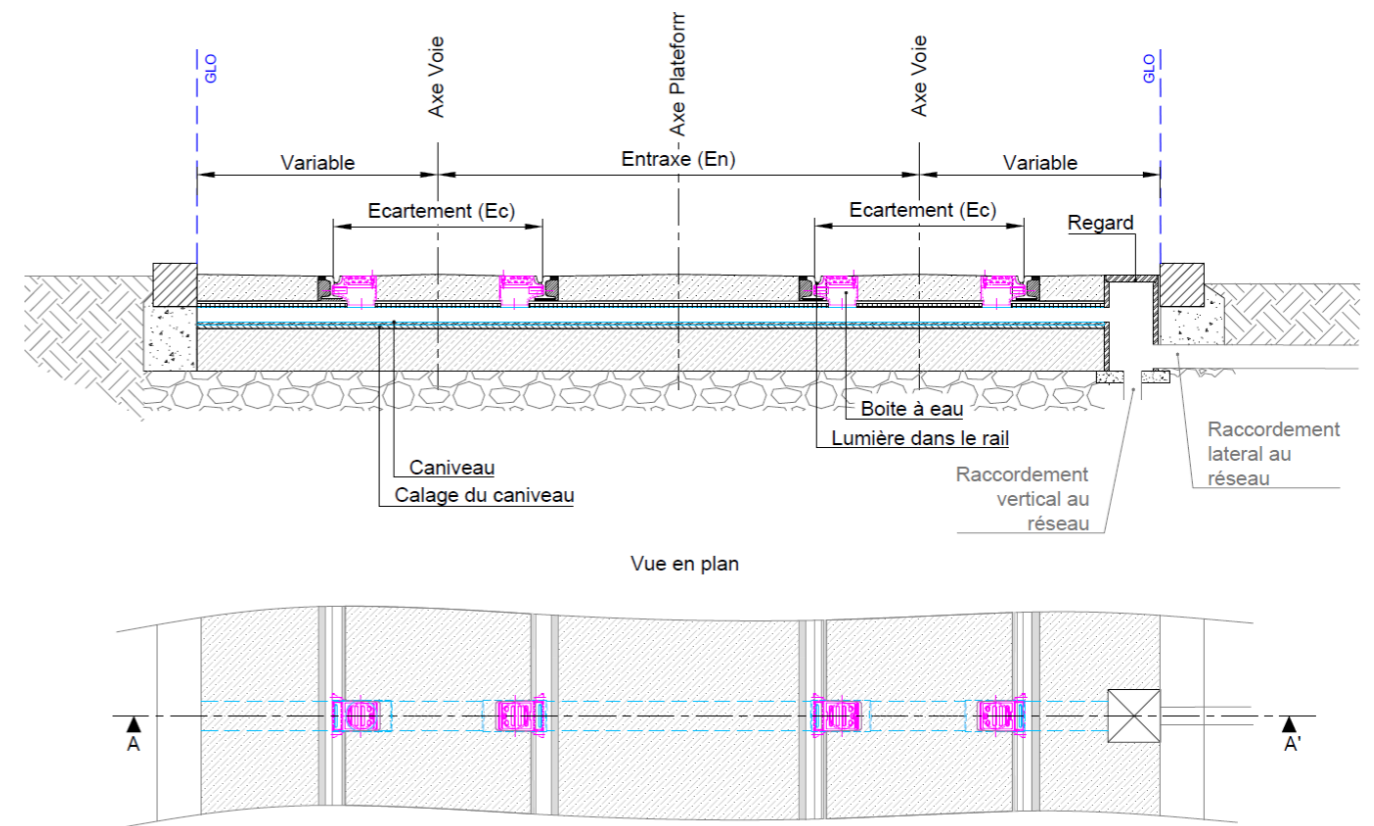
coupes type de plateforme imperméable (ou perméable) - Principe d'assainissement par boîte à eau
